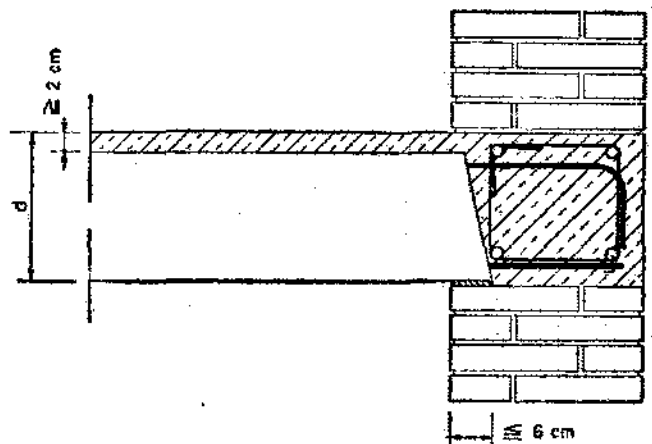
Cadena con viguetas autorresistentes con suficiente armadura saliente
